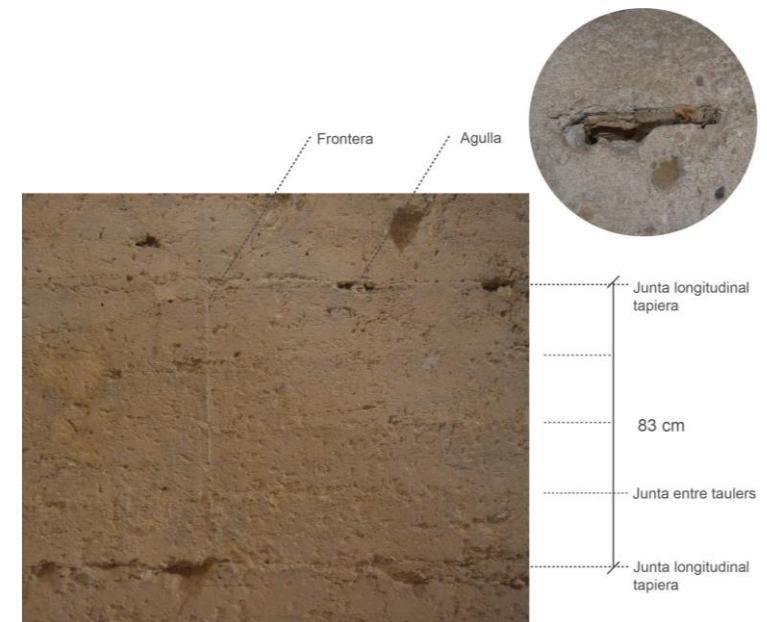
18 Detall de la tàpia, torre de Benifaió. Elaboració pròpia
